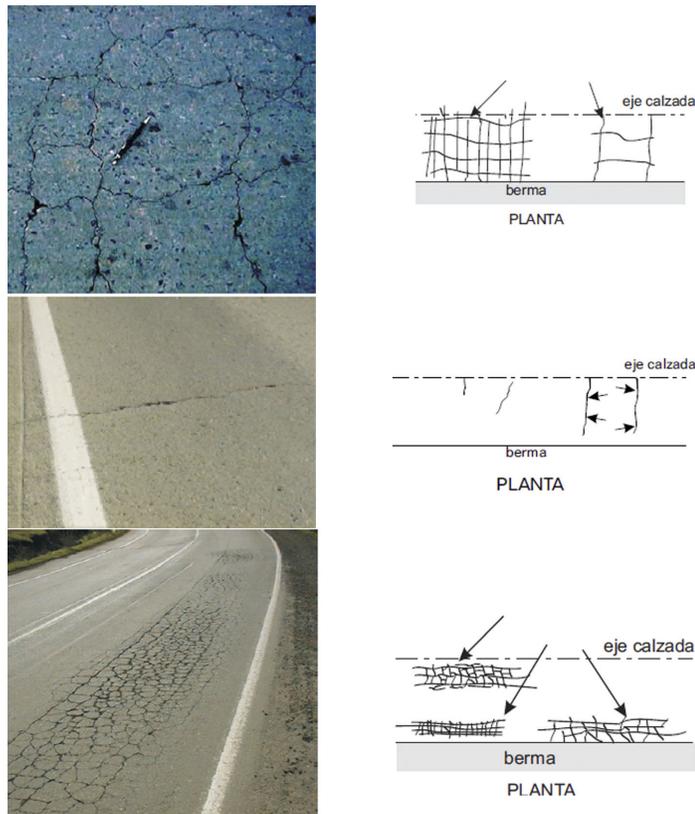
Fisuración de bloque, transversal y de fatiga. Fuente: [32]
